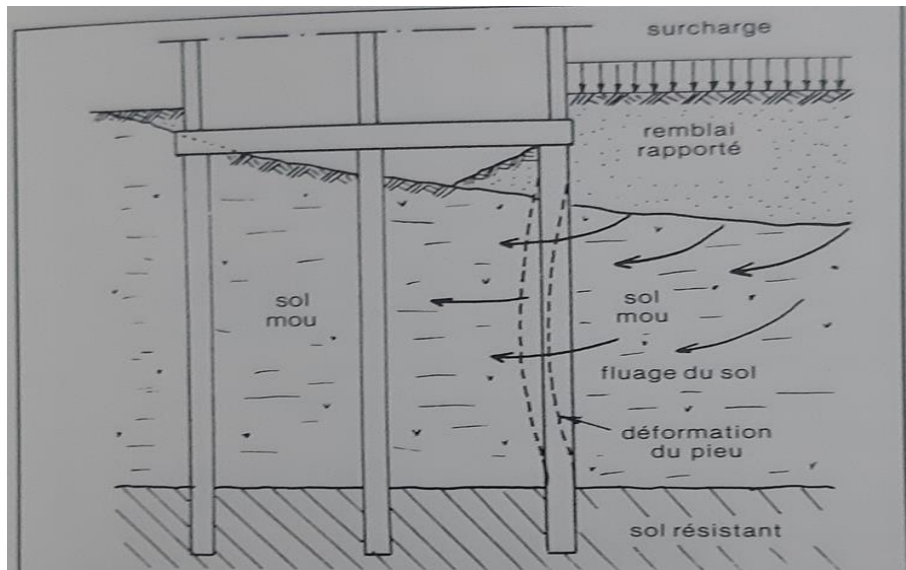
Principe des poussées obliques sur les pieux [16]
